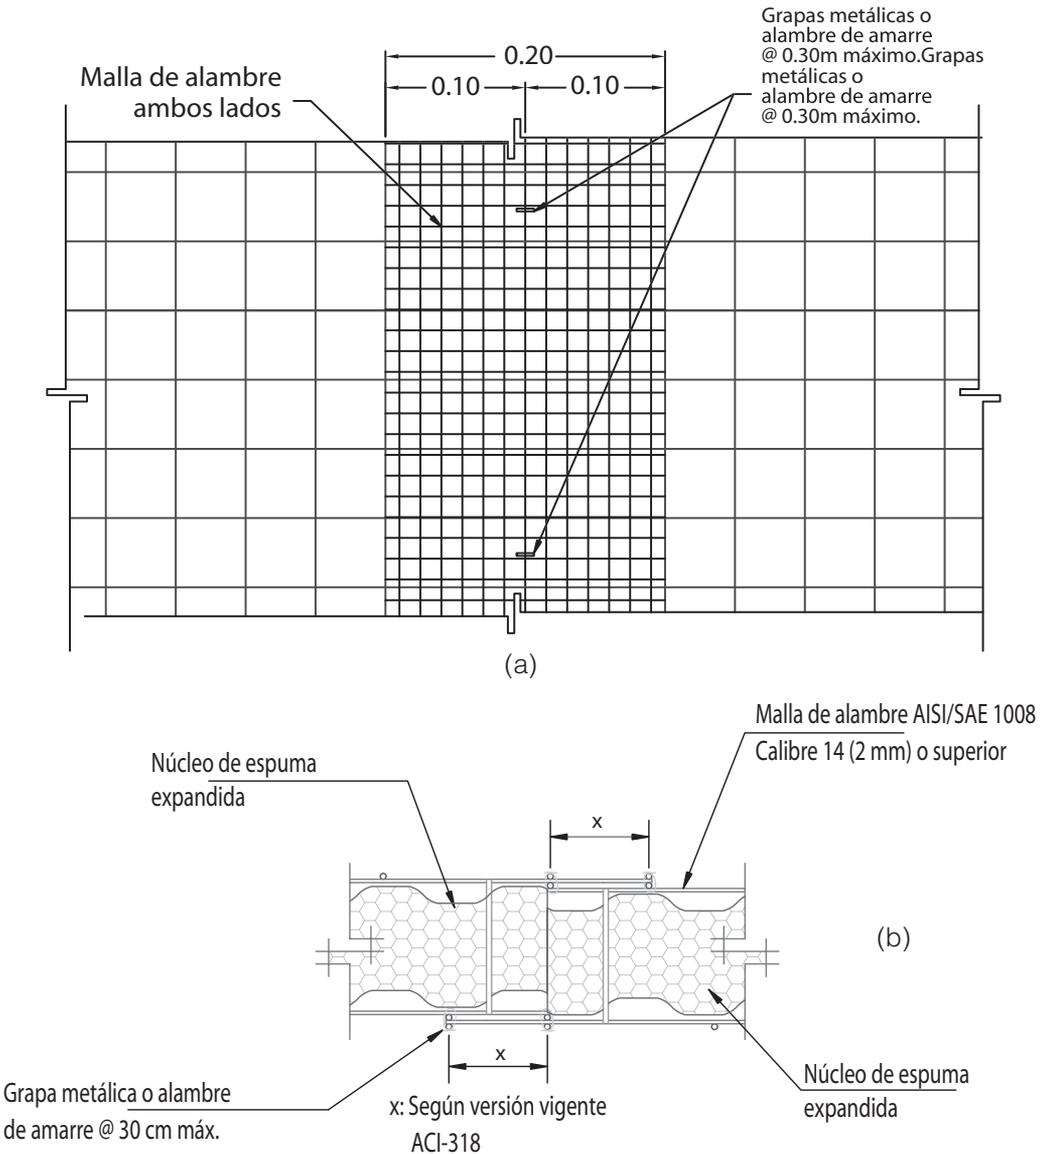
Detalle de posibles conexiones panel a panel en pared tipo emparedado.
